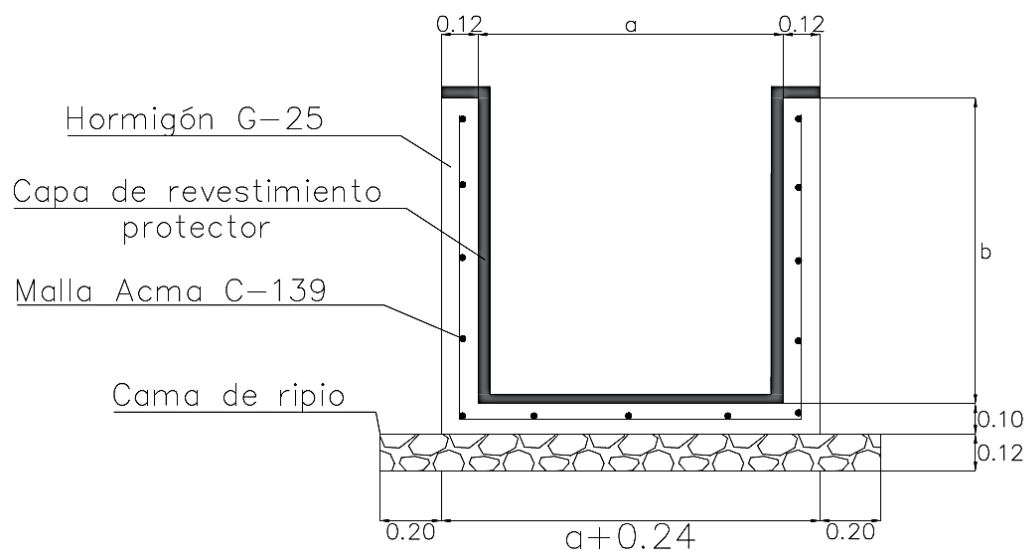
Sección tipo canal con revestimiento protector impermeable (cotas en m). Fuente: elaboración propia.
